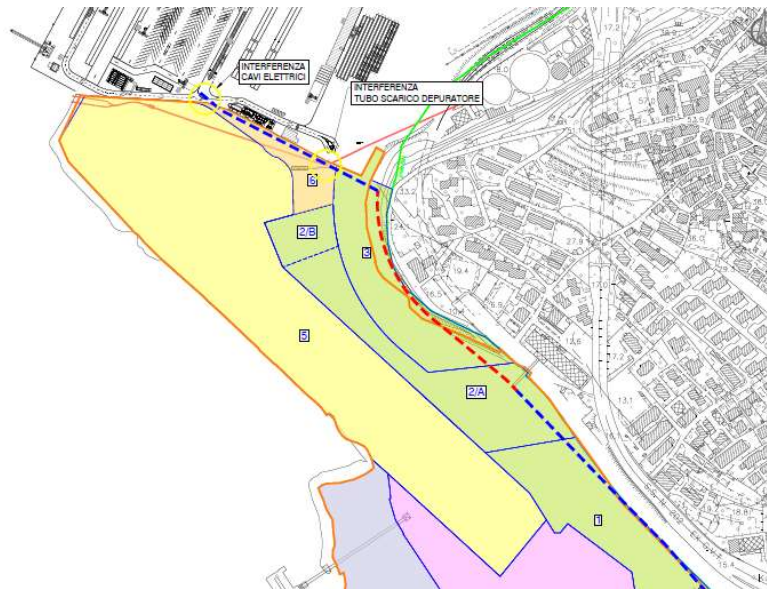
Planimetria dell'intervento (in linea rossa tratteggiata la paratia).
